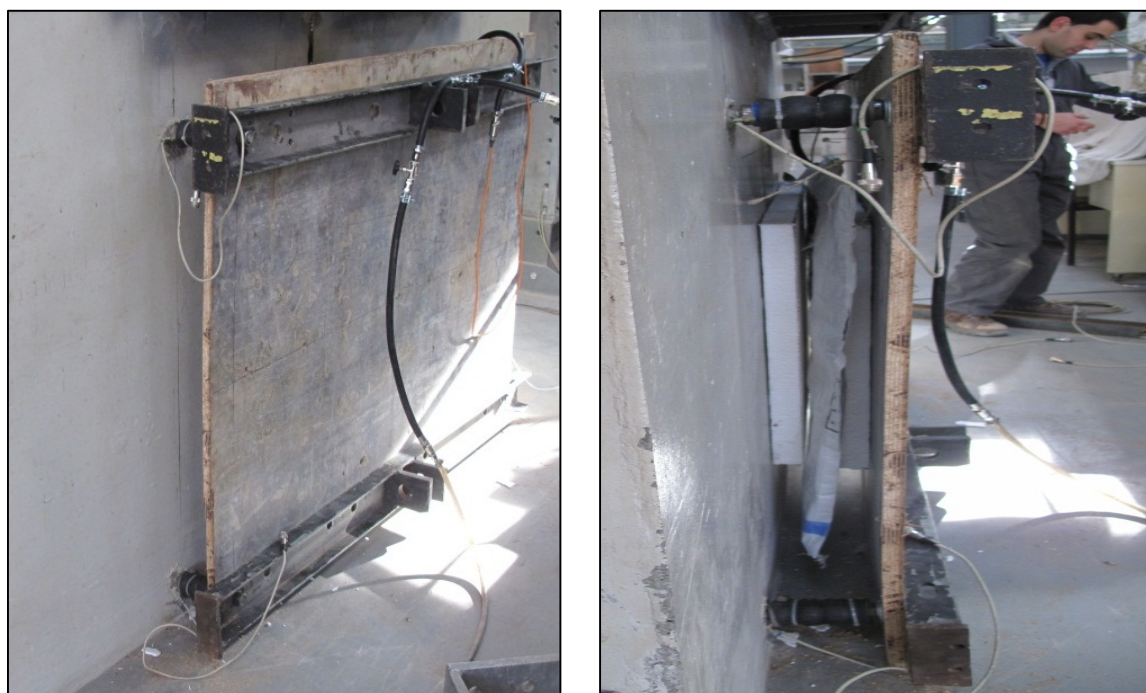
Setup de ensaio #1 – Preparação e colocação da bolsa de ar.
